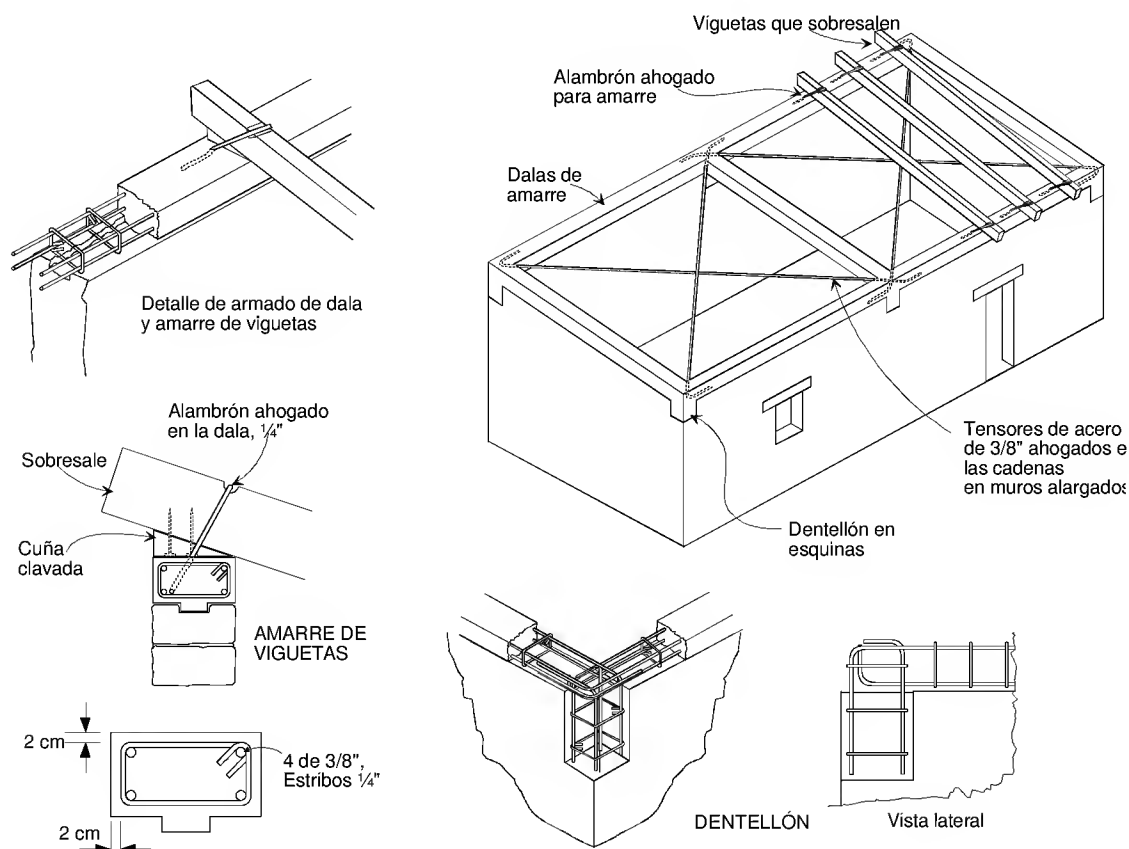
Construcción de dalas de cerramiento de concreto reforzado
